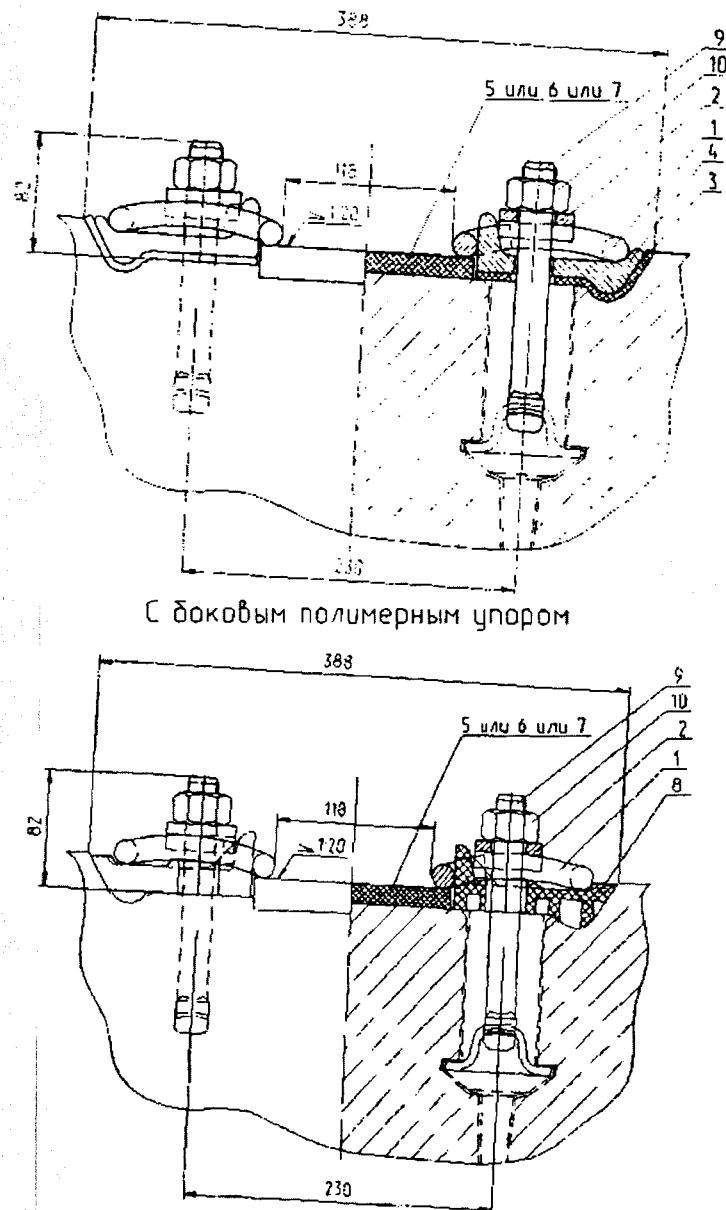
Упор боковой полимерный (для скрепления СМ-1)
